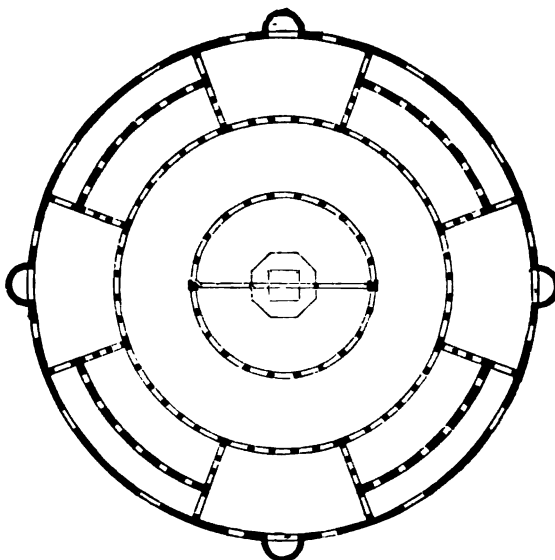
Grundriss von S. Stefano rotondo in Rom
